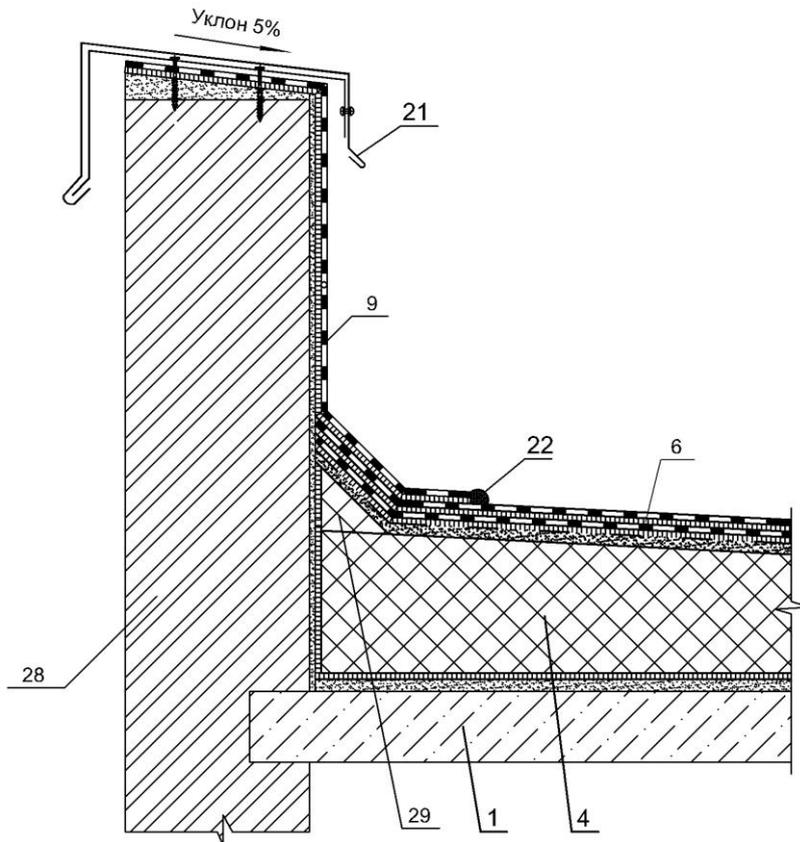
Примыкание традиционной неэксплуатируемой кровли к фундаменту под вентилятор.
